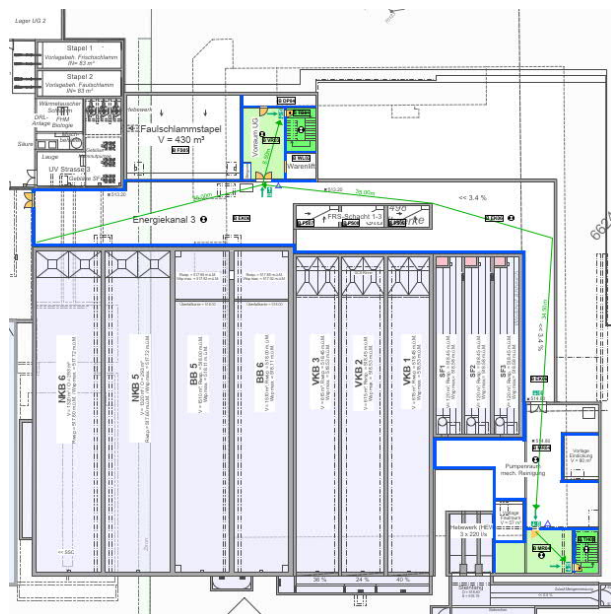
Planausschnitt; Grundriss UG
